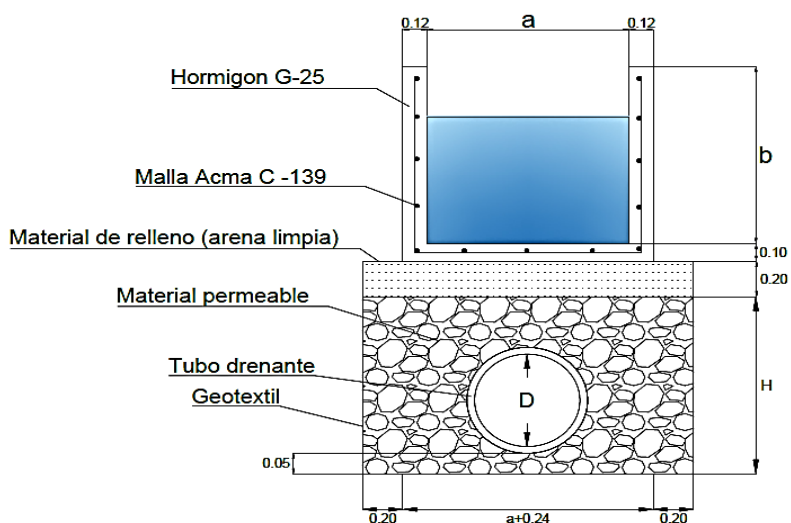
Sección tipo subdren de grava para canal revestido de hormigón armado (cotas en m). Fuente: elaboración propia basado en manual de carreteras volumen 4.
